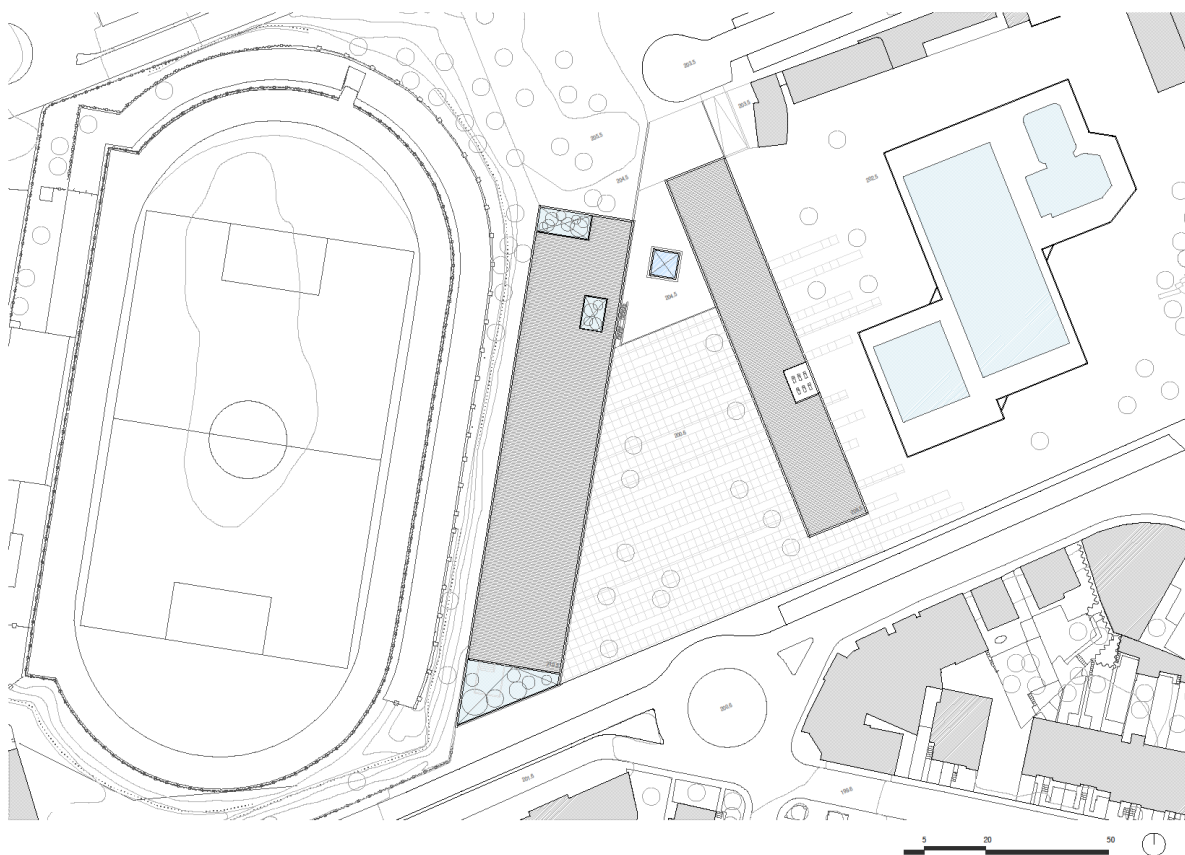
Proposta: Planta de Implantação, Fonte: Autor
